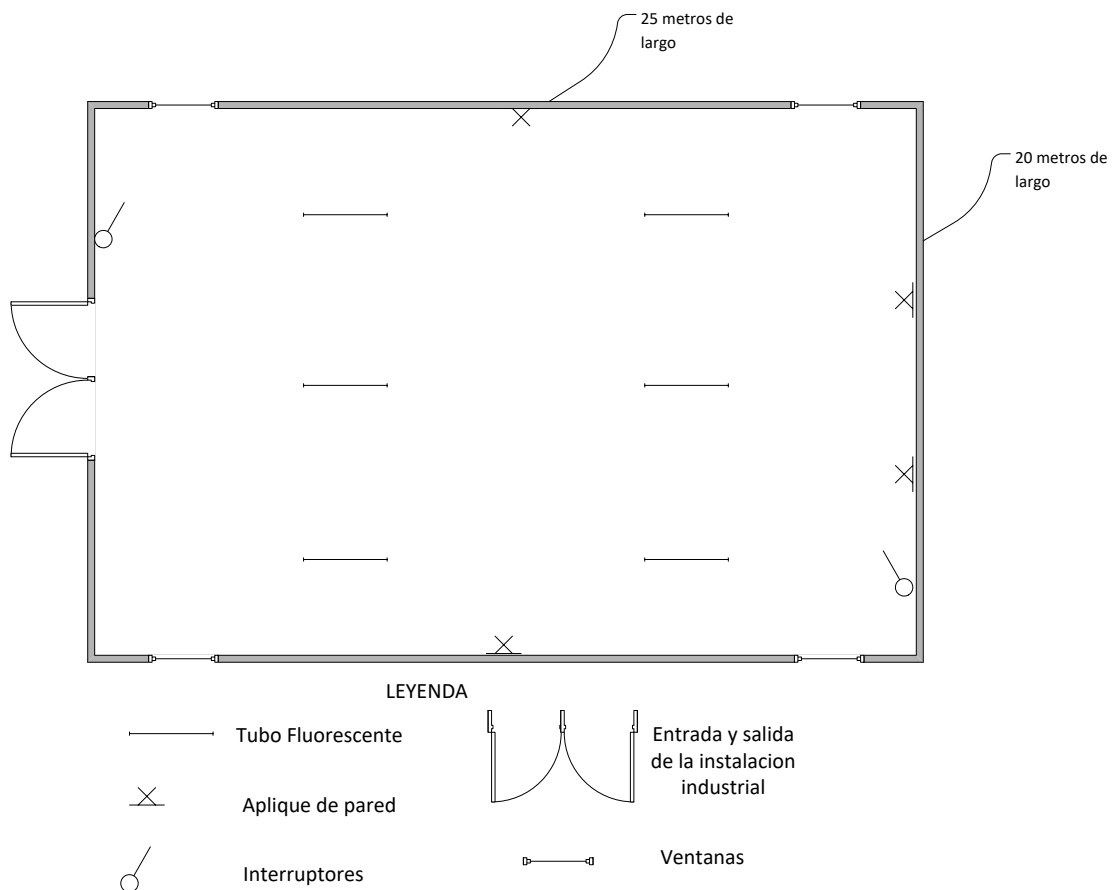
Plano de planta actual con distribución de luminarias y ventanas
